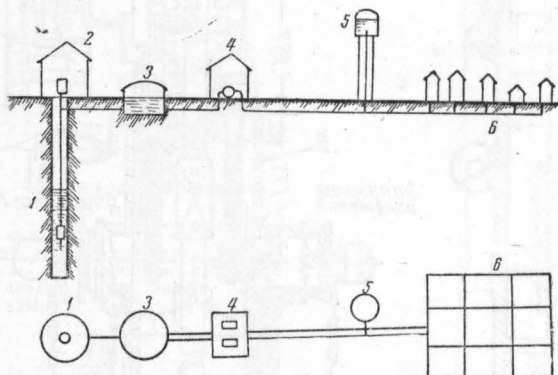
Схема водопроводных сооружений при заборе подземных вод:
